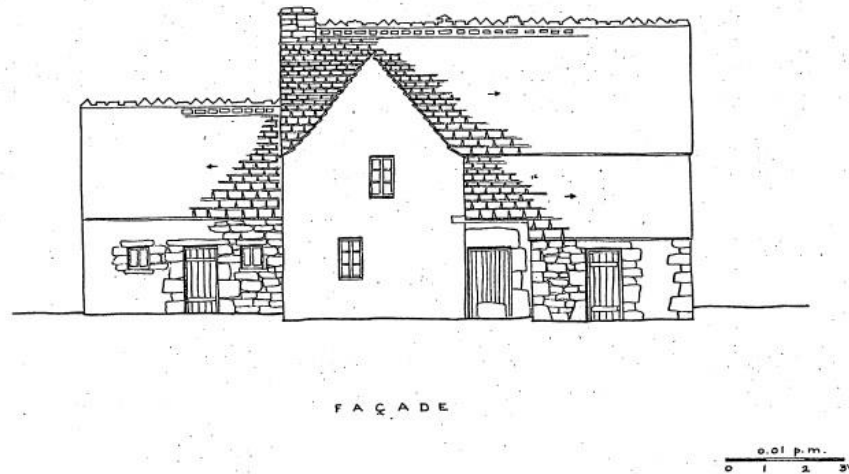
Façade d'une maison de ferme, Sizun. Chantier 1445
